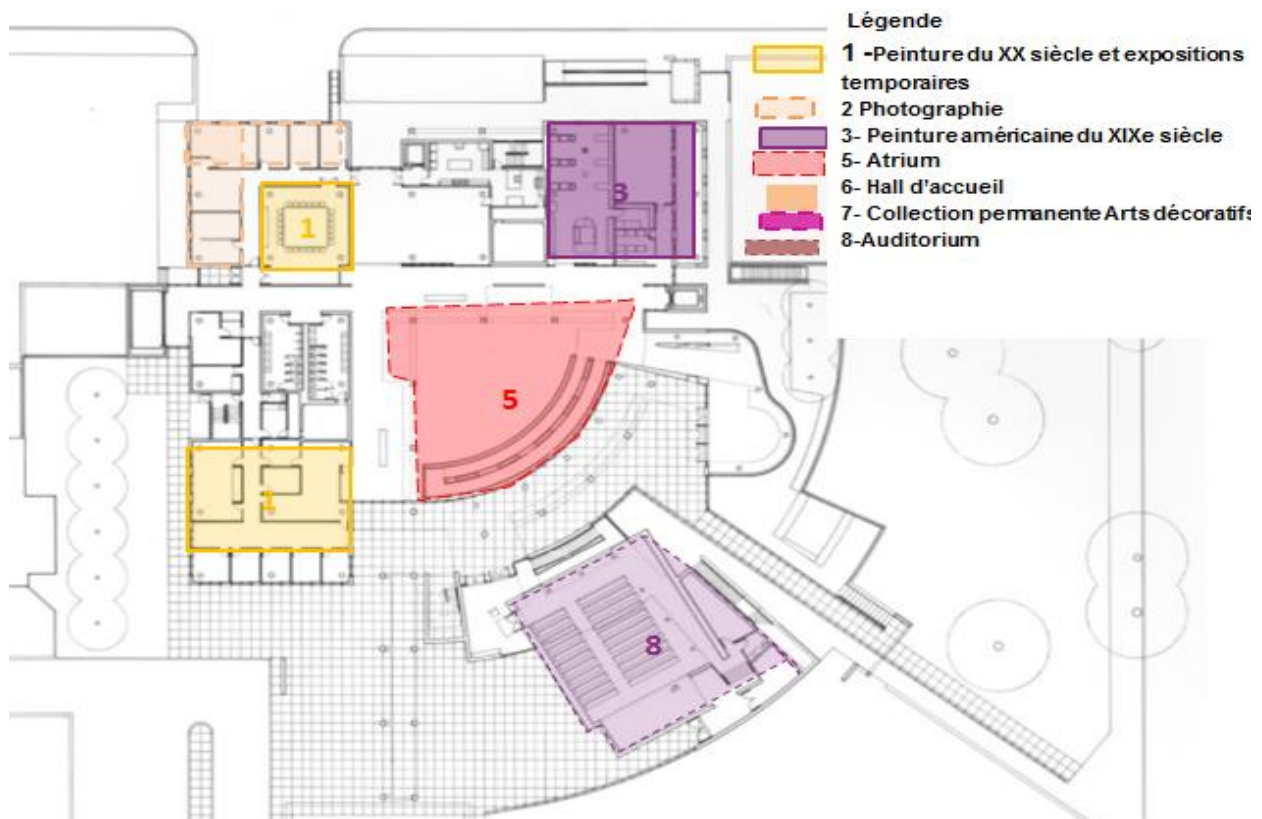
plan étage du le musée l'Atlanta. Source : www.archdaily.com
